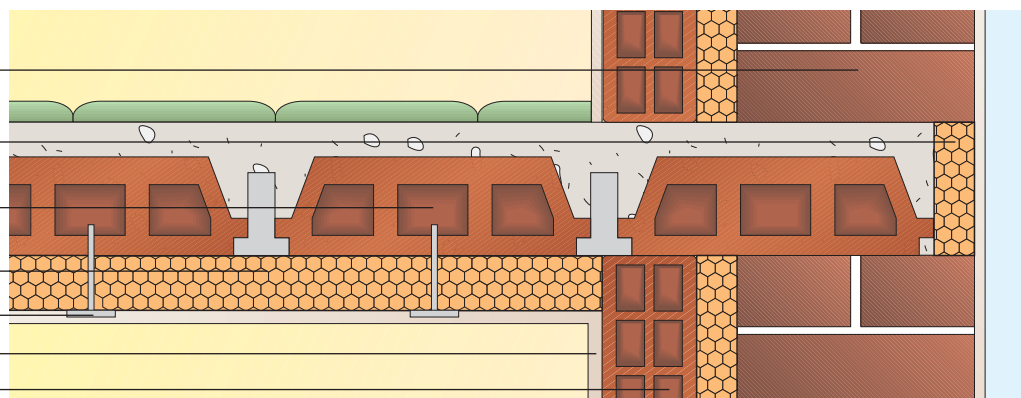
Aislamiento de forjados intermedios en plano inferior
